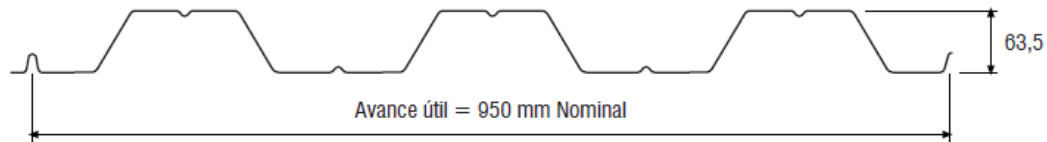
Vista transversal de losa colaborante más capa de hormigón [79].
